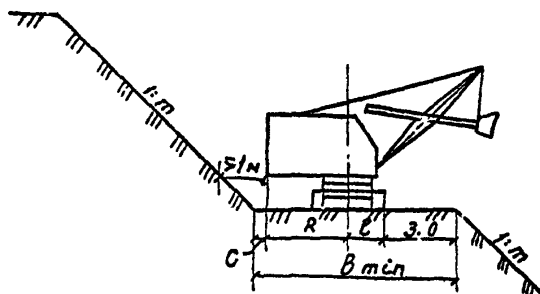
а Схема определения минимально допустимой ширины подки при разработке мягких грунтов.
